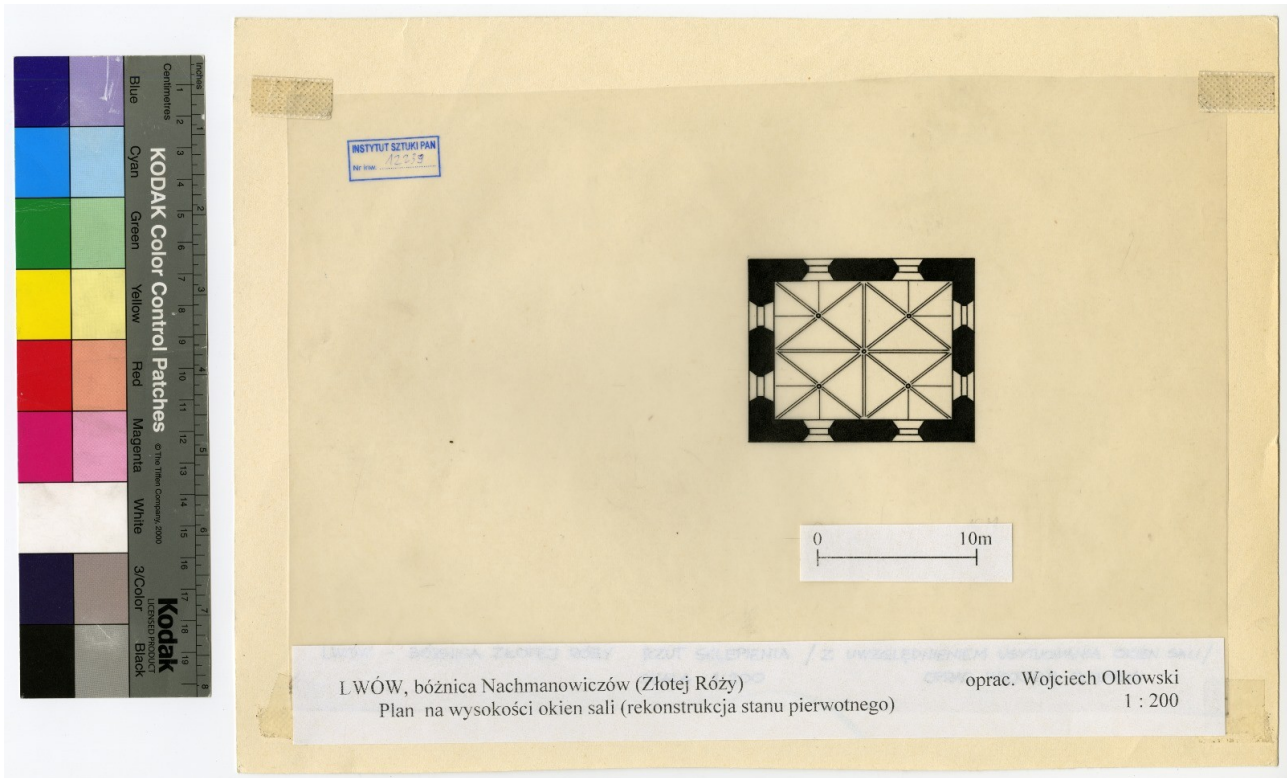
Grundriss Dach Hauptraum um 1609
